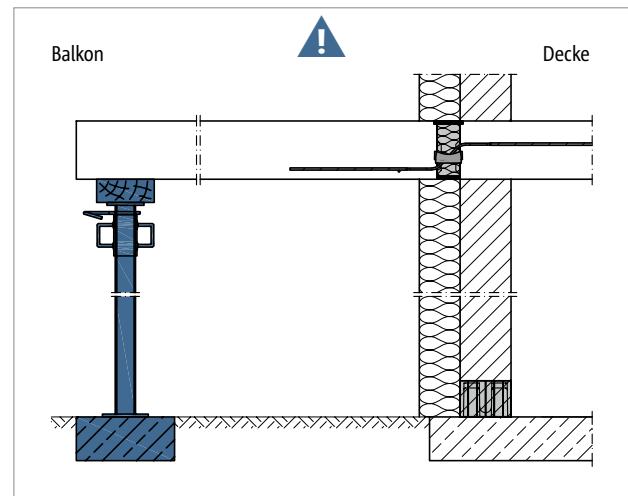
Schöck Isokorb® T Typ QL: Stützung durchgängig erforderlich
